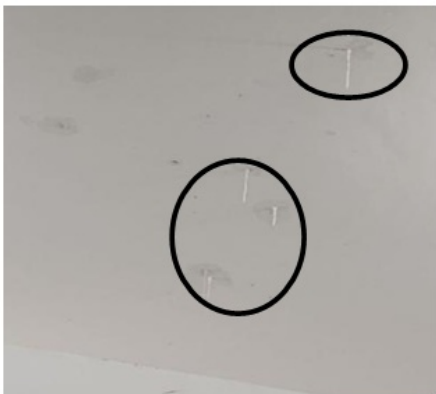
estalactites formadas sob a laje do reservatório elevado da retrolavagem (teto do laboratório) que evidenciam a necessidade impermeabilização
